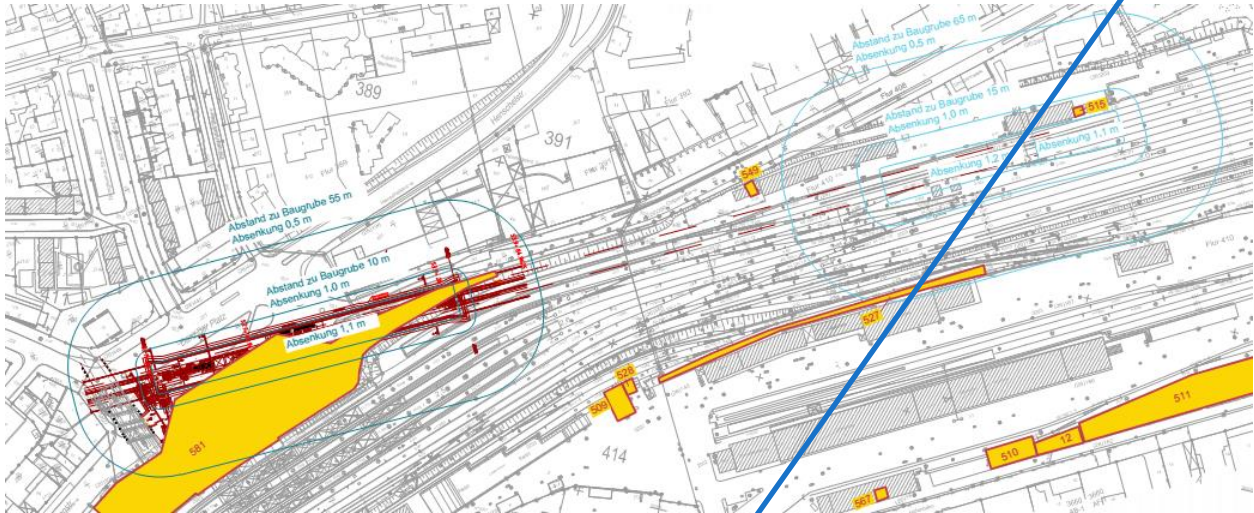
Absenktichter Baugrube Rampe Ost / Stationsbauwerk, Ausschnitt Lageplan [A13]
